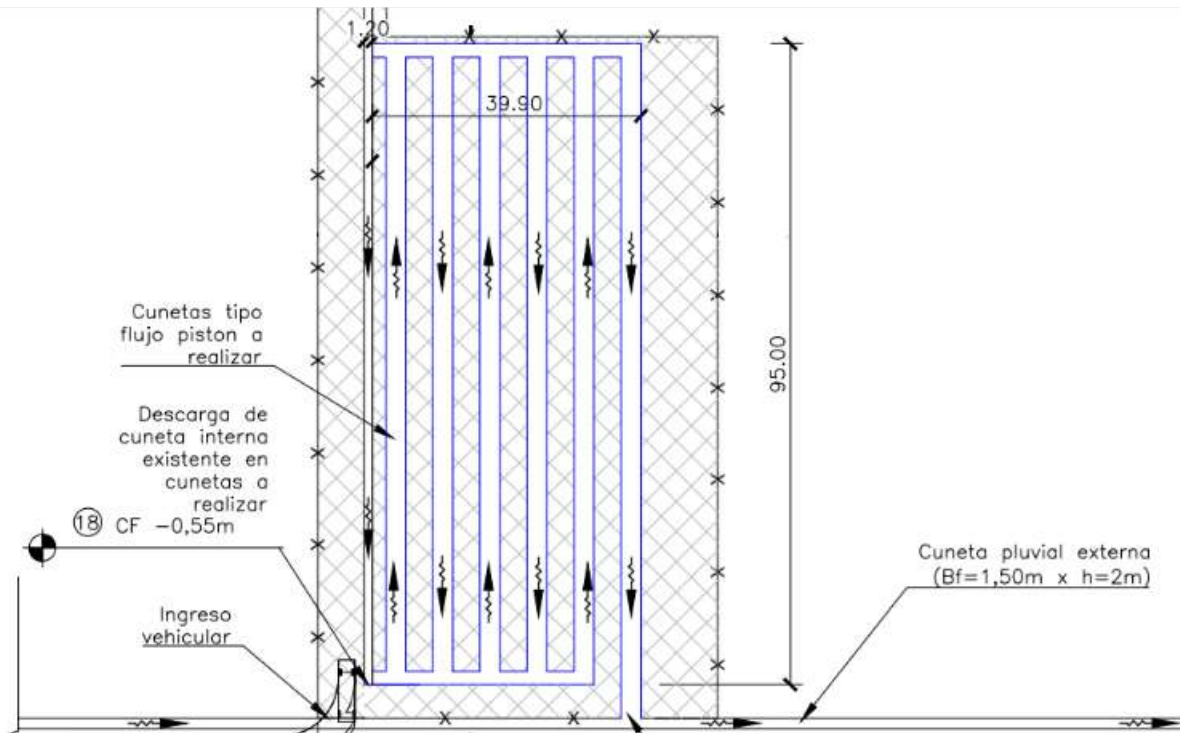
Sistema de tratamiento de efluentes – Fuente de elaboración propia
